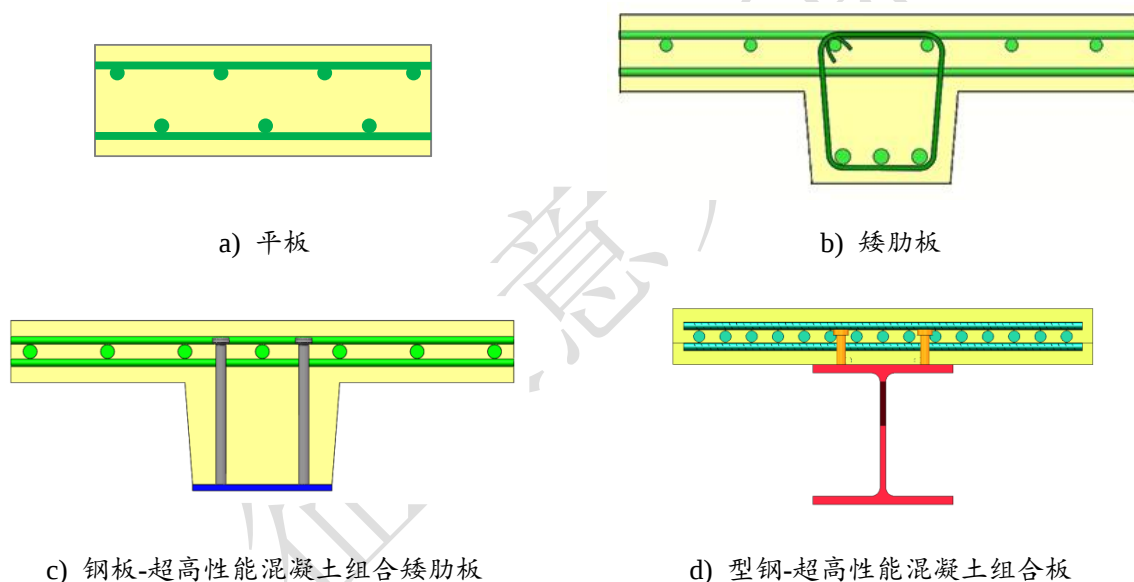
超高性能混凝土桥面板构造形式示意图
